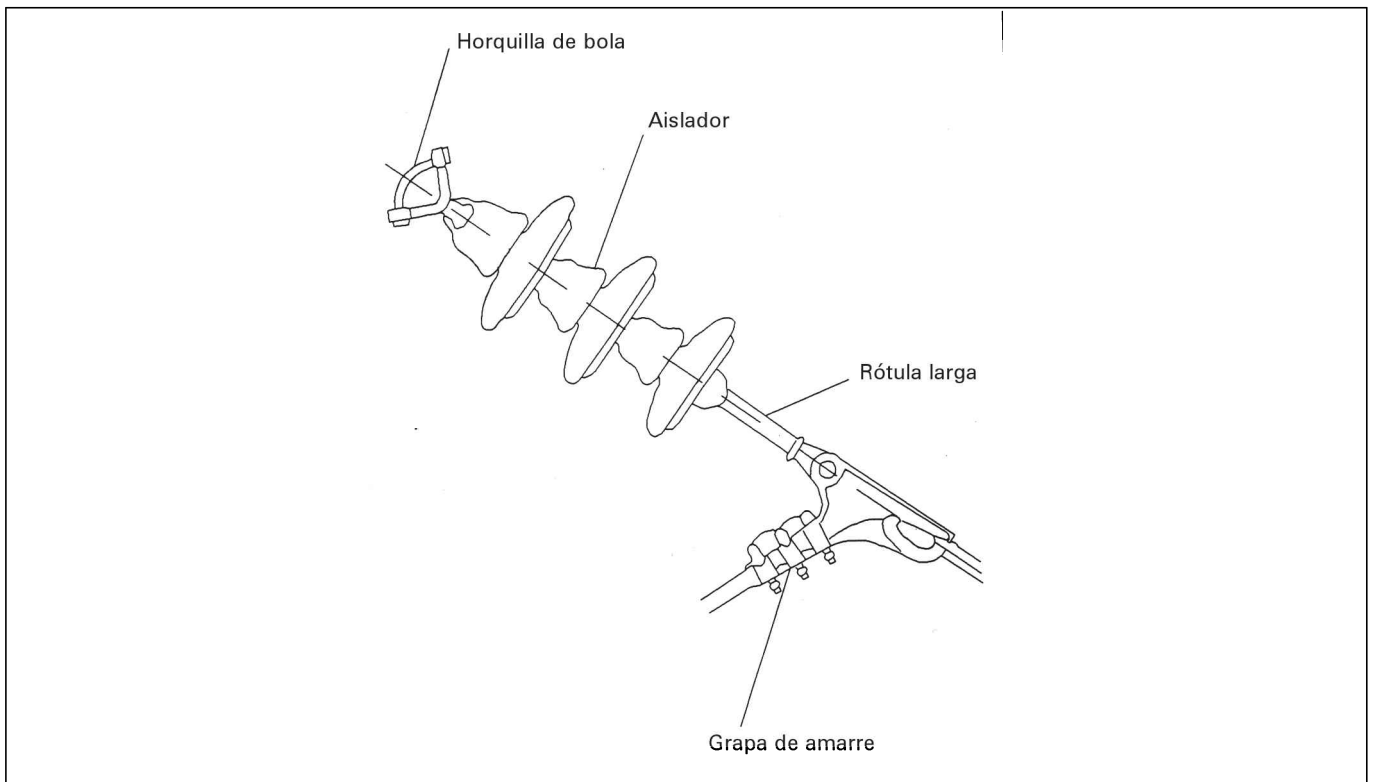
Cadenas de amarre con aisladores de vidrio.
